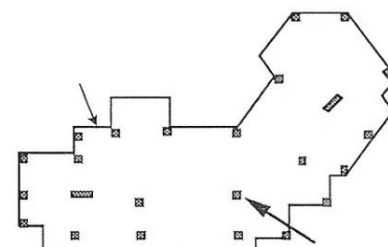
Irregularidade estrutural em planta (Baggio, et al., 2007).
